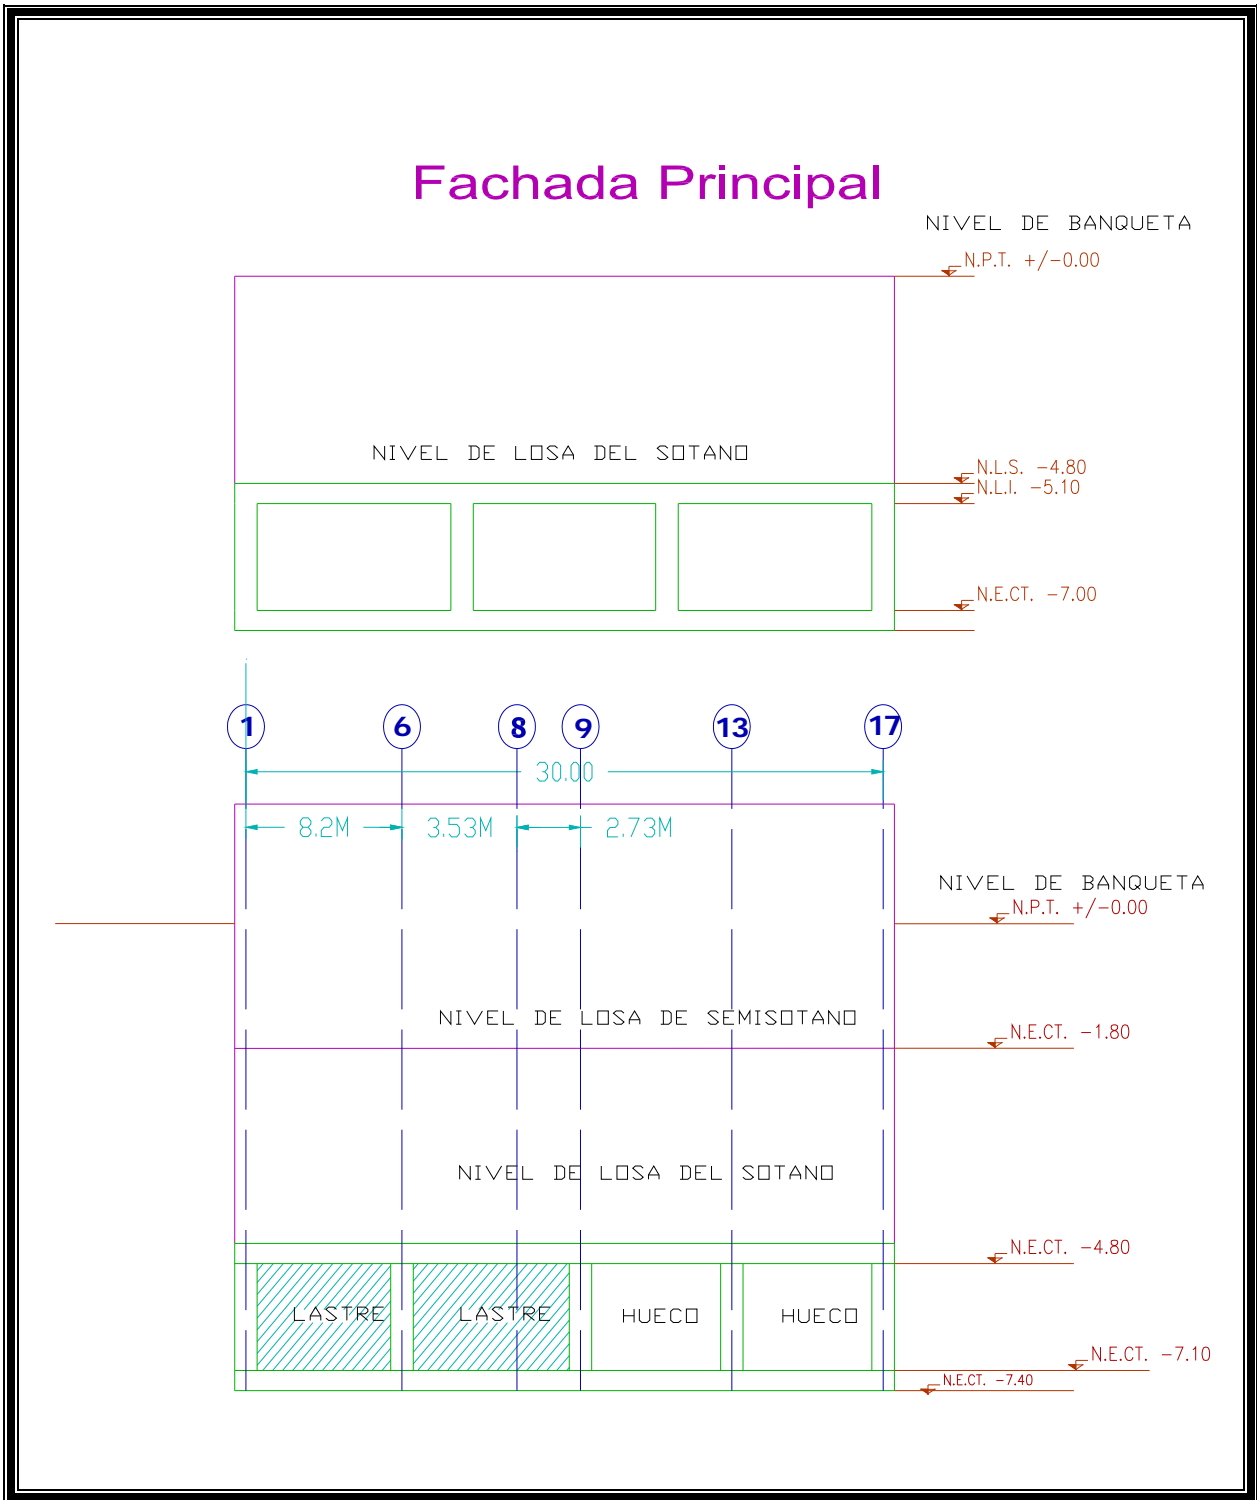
CAJÓN DE CIMENTACIÓN COMPENSADO TOTALMENTE Y CON LASTRE
